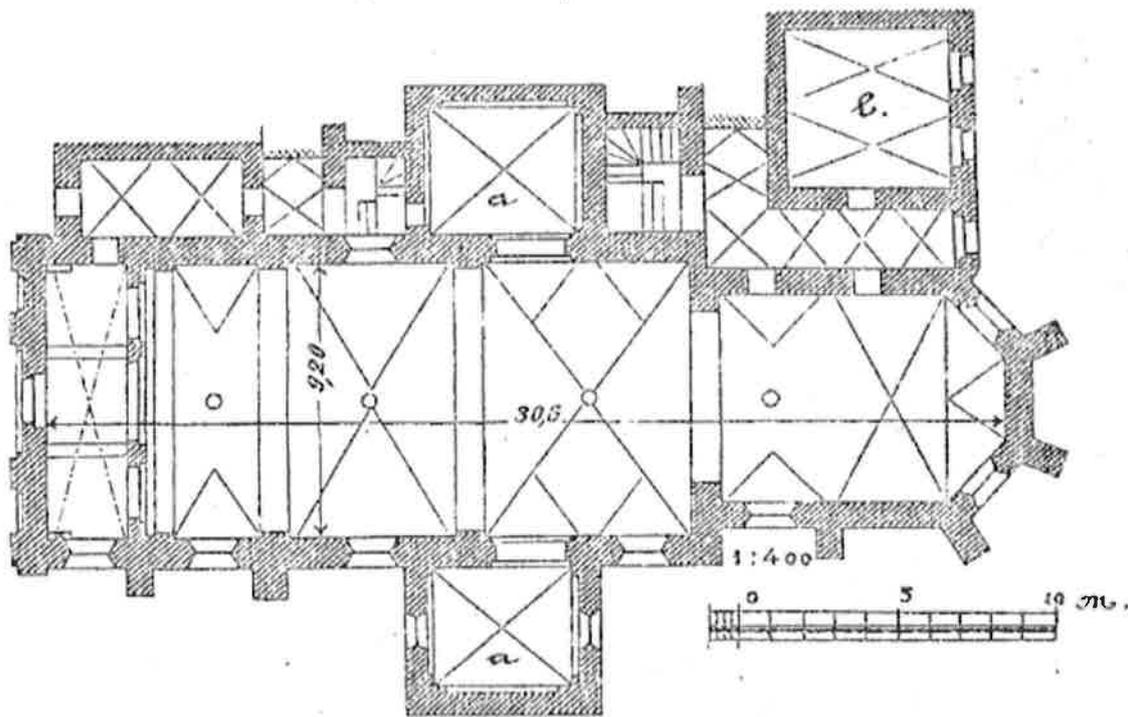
Neustadt. Grundriss der Klosterkirche.
